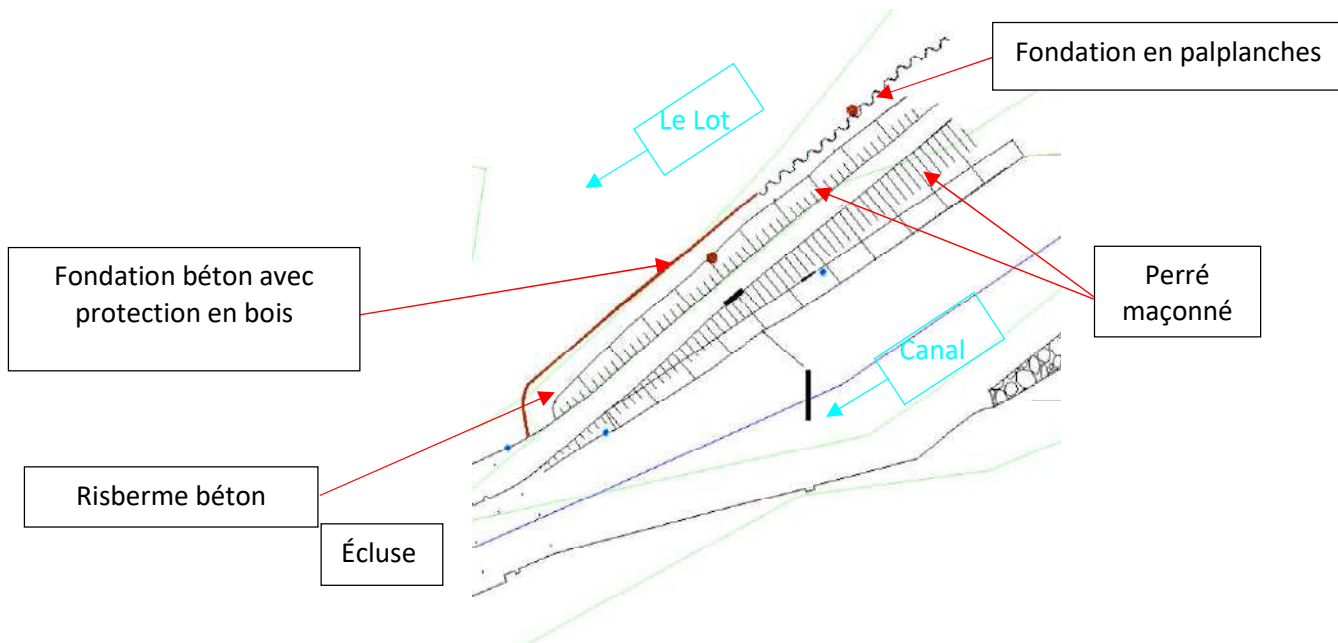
Vue en plan du guideau maçonné – Ganil (BIEF).
